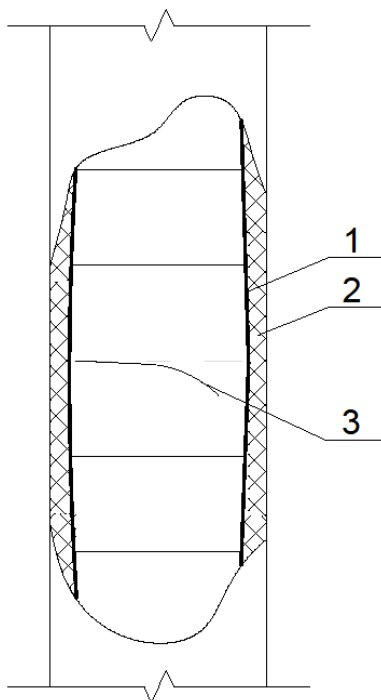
Схема дефекта – отрыв поперечной арматуры колонны: 1 – выгиб продольной арматуры, 2 – отслоение защитного слоя бетона, 3 – отрыв поперечной арматуры
